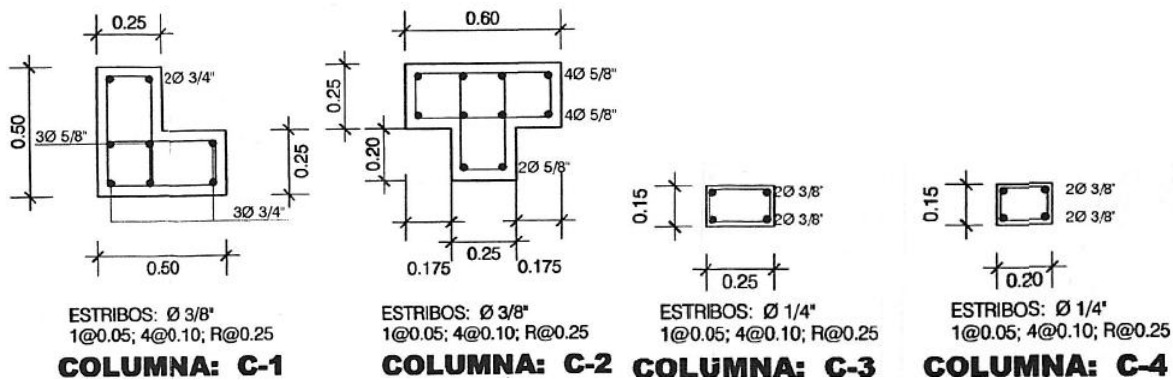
Revisión de detalles de las columnas en los planos de la estructura de la institución educativa N° 10386
